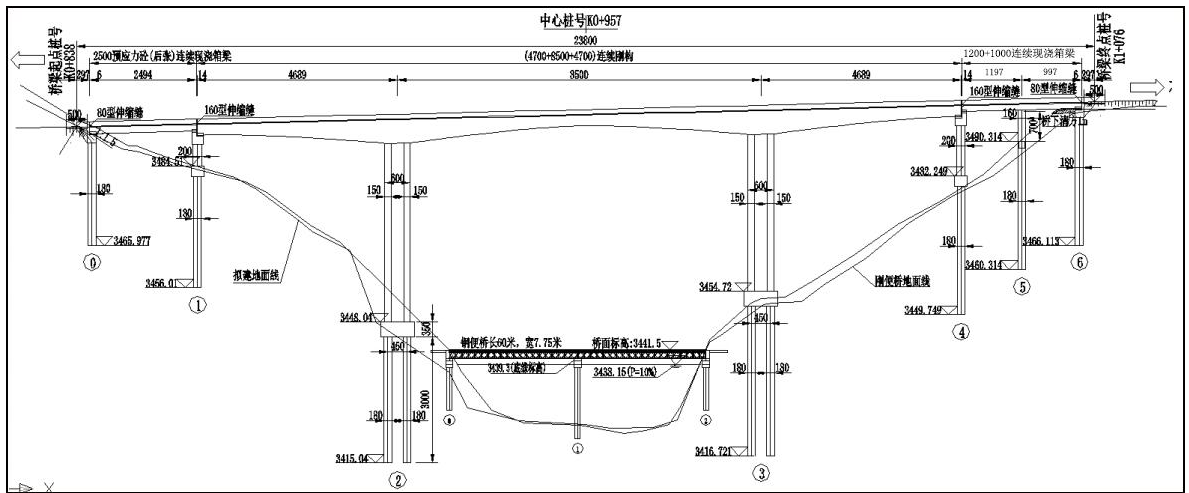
满真金沙江大桥与施工便桥立面布置示意图
